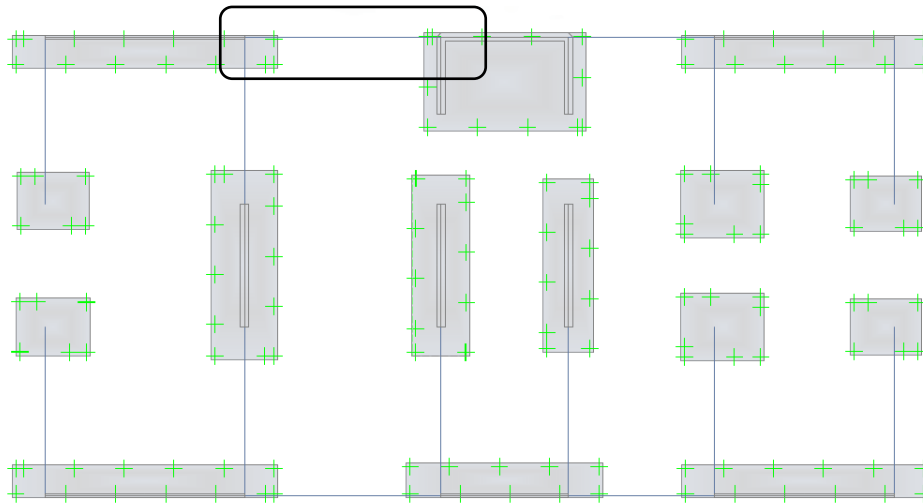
Vista en planta modelo de cimentaciones en software Safe.
